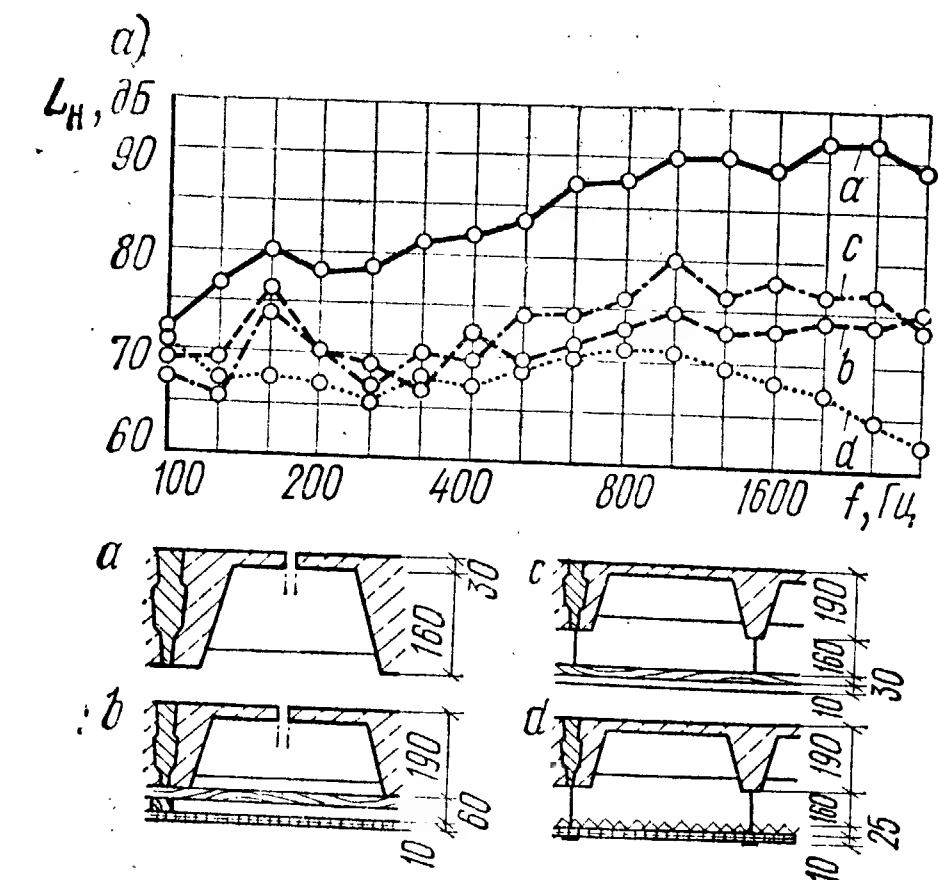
Звукоизоляция несущей части перекрытия (10); п. б): а — по [14], п. в — по [3]
